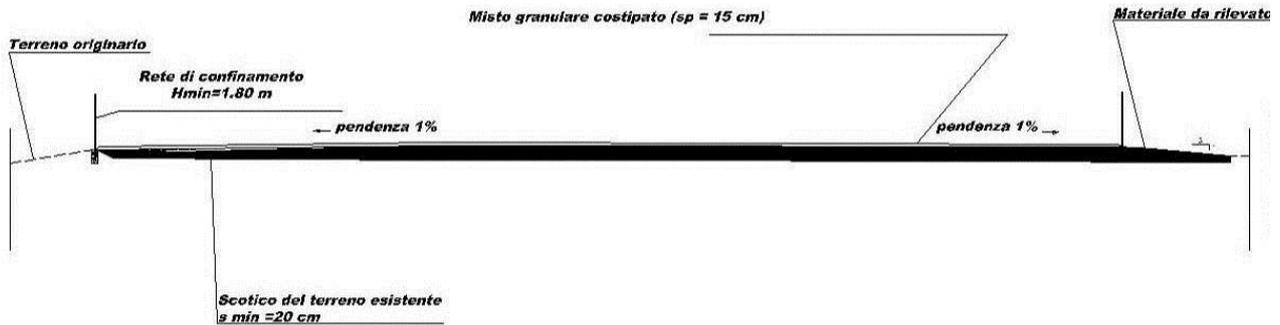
PARTICOLARE DELLA PAVIMENTAZIONE DELLE AREE DI CANTIERE
